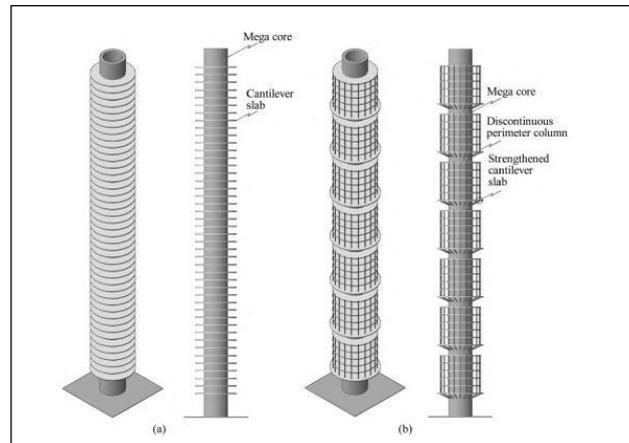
Les dalles dans les méga noyaux centraux(a) dalle en porte e faux, (b) dalle en porte a faux renforcée
